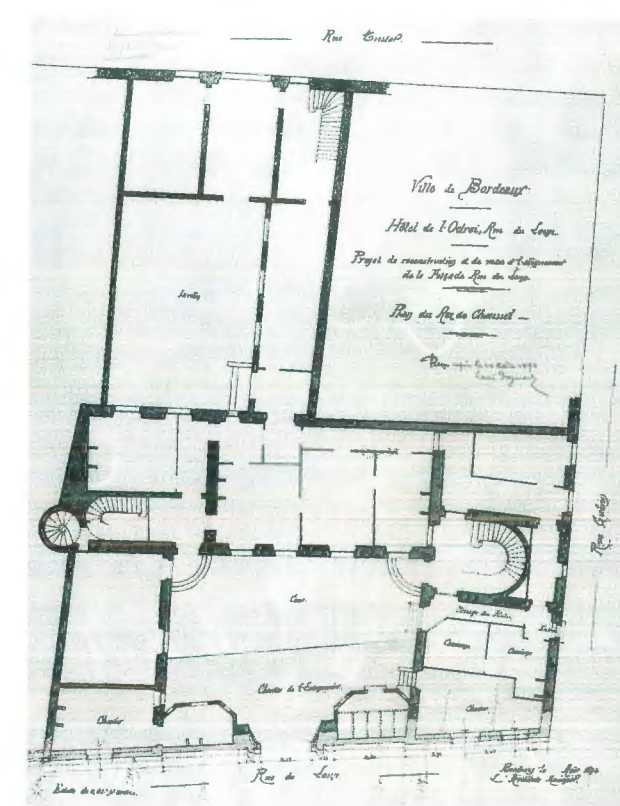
Plan du rez-de-chaussée de l'hôtel de l'Octroi, projet de reconstruction, 1894. (Cliché A.M.BX.)
